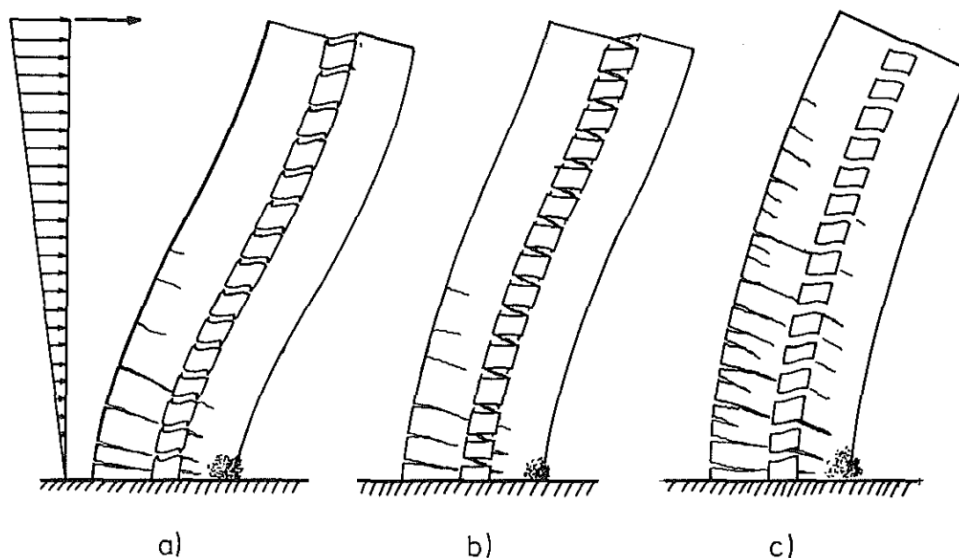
Modos de Falla en Muros de Hormigón Acoplados con Vigas [43]
